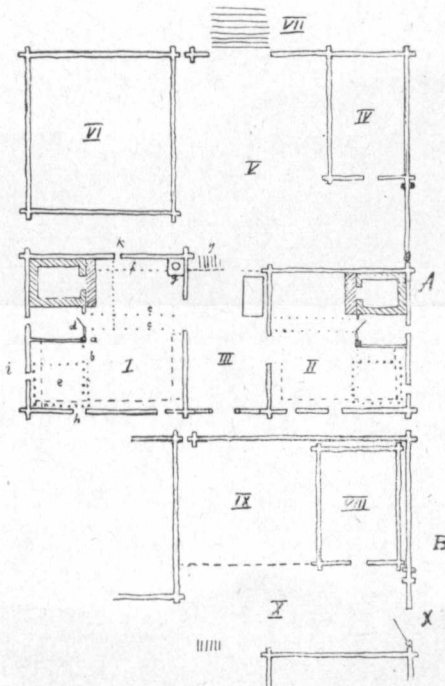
Grundriss desselben hauses wie in abb. 11.
